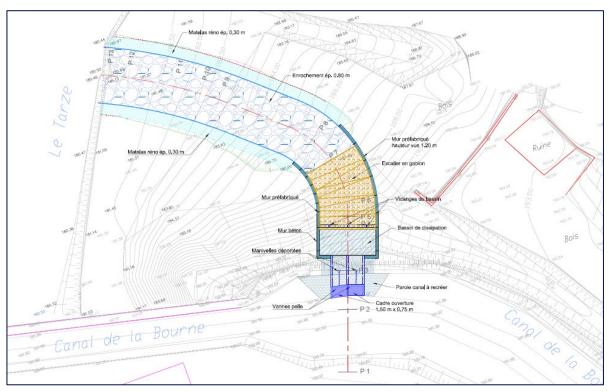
Vue en plan de l'ouvrage (Source : AVP)
